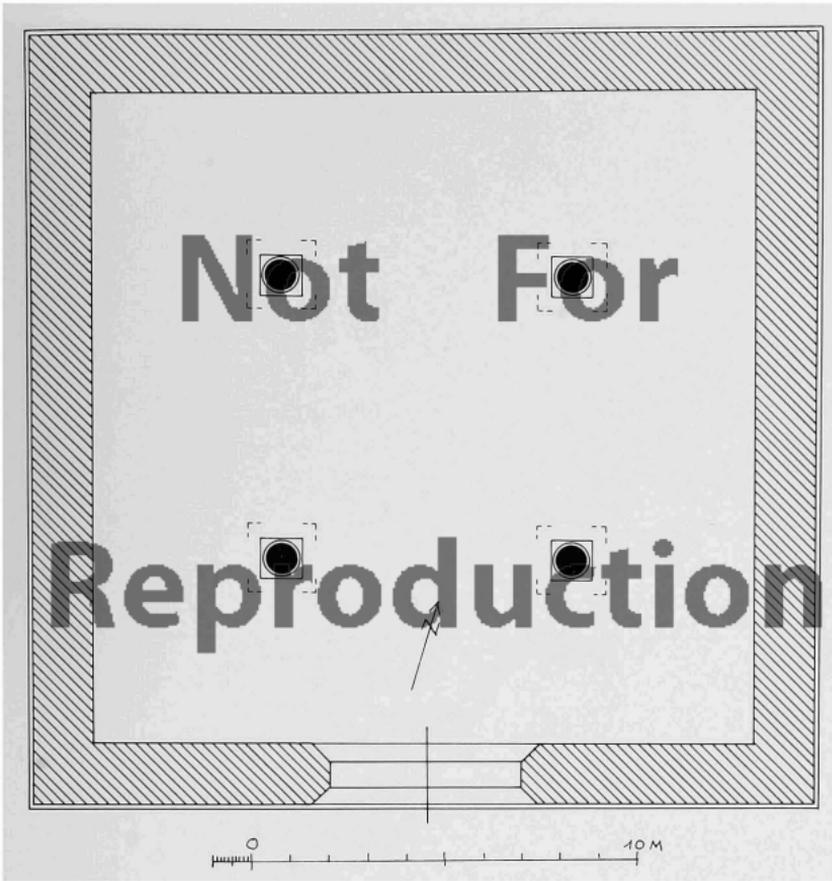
Viersäulenbau westlich des Sees. Grundriß (Zeichnung W. Kleiss)
